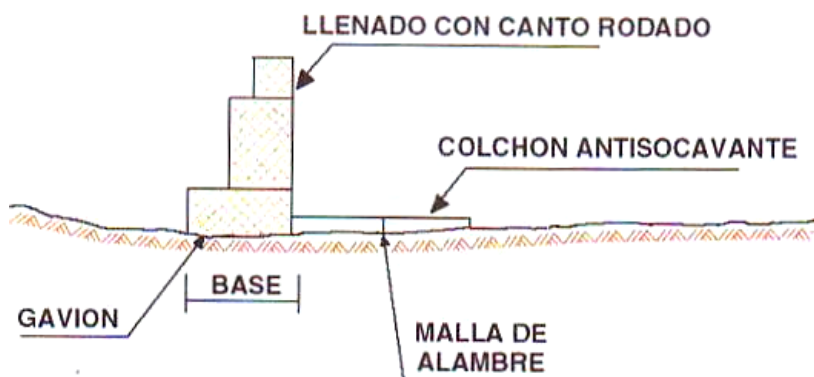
Esquema de la instalación de un gavión con colchón antisocavante
